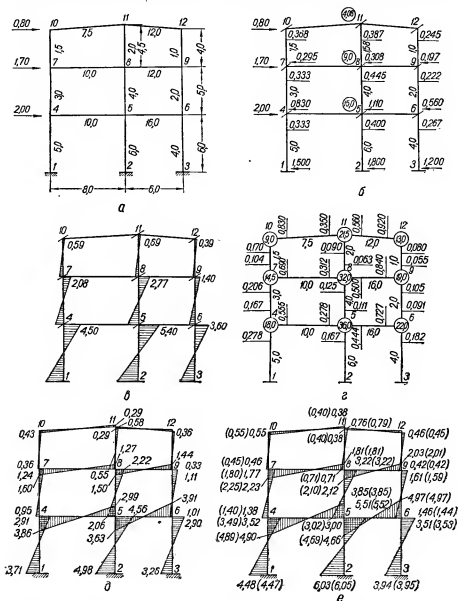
Расчет двухпролетной трехэтажной рамы на ветровую нагрузку:
